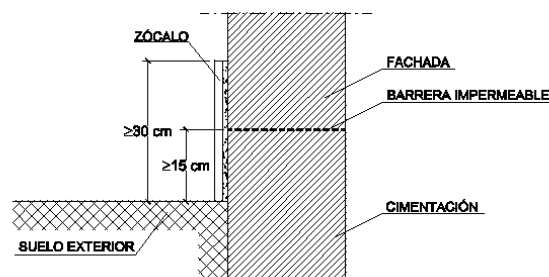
Ejemplo de arranque de la fachada desde la cimentación
